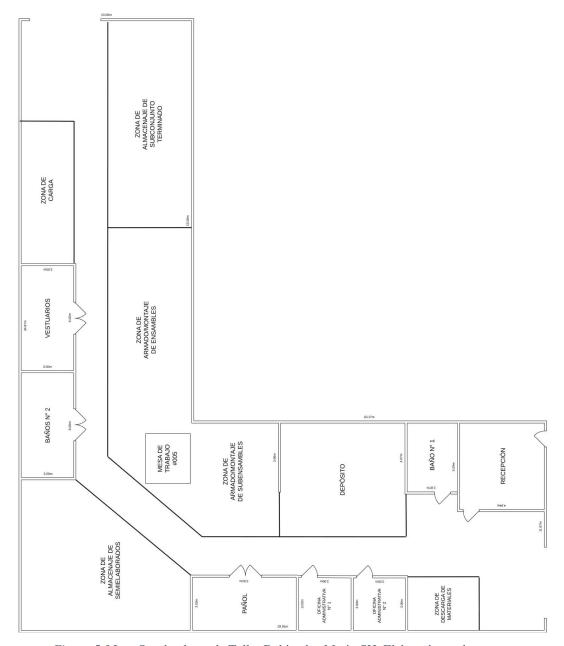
Lay Out de planta de Taller Bobinados Mario SH. Elaborado por los autores.
